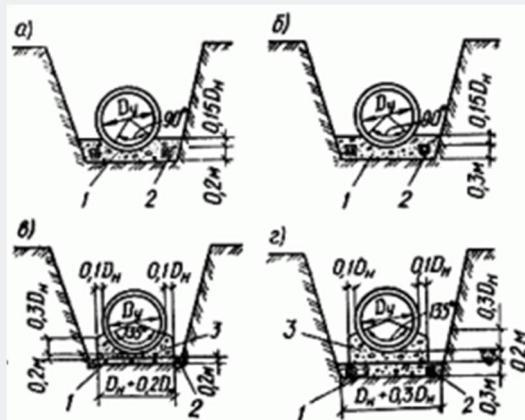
Основания для бетонных и железобетонных трубопроводов условным проходом 600 мм и более, прокладываемых в водонасыщенных грунтах
